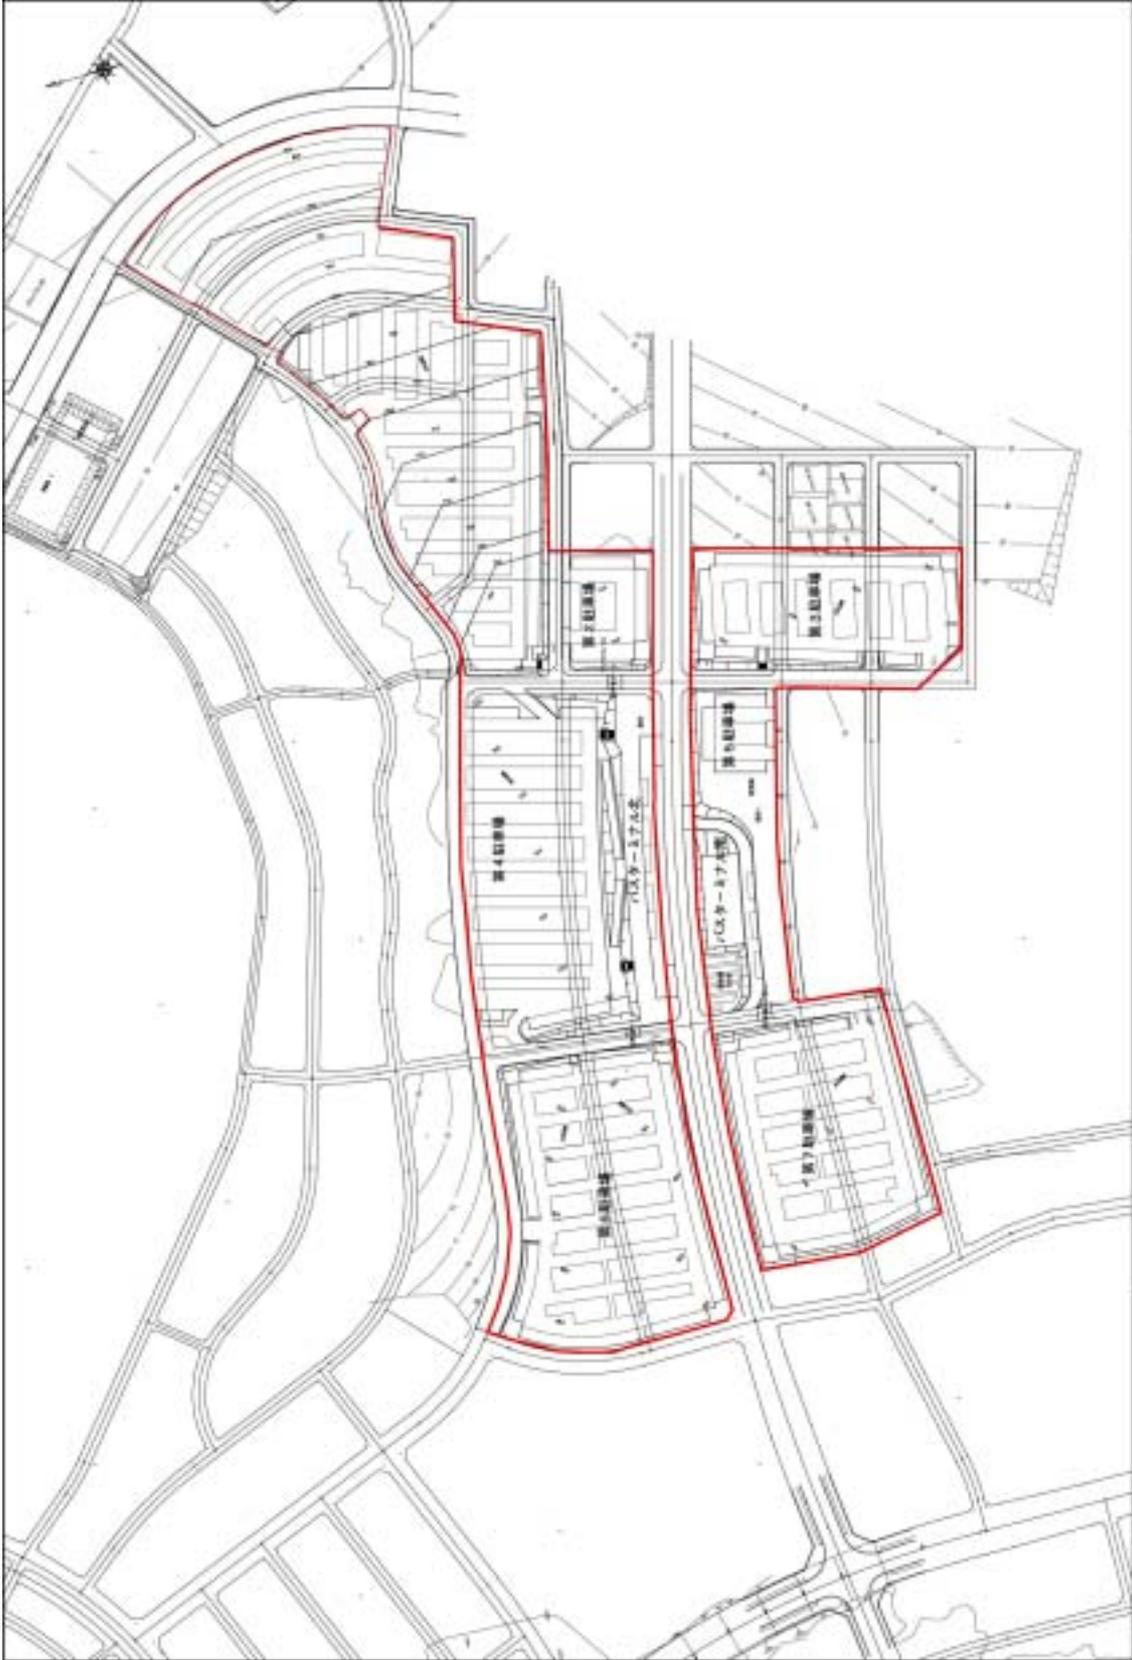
(3) 自家用車駐車場の計画平面図（ながくて南駐車場）
